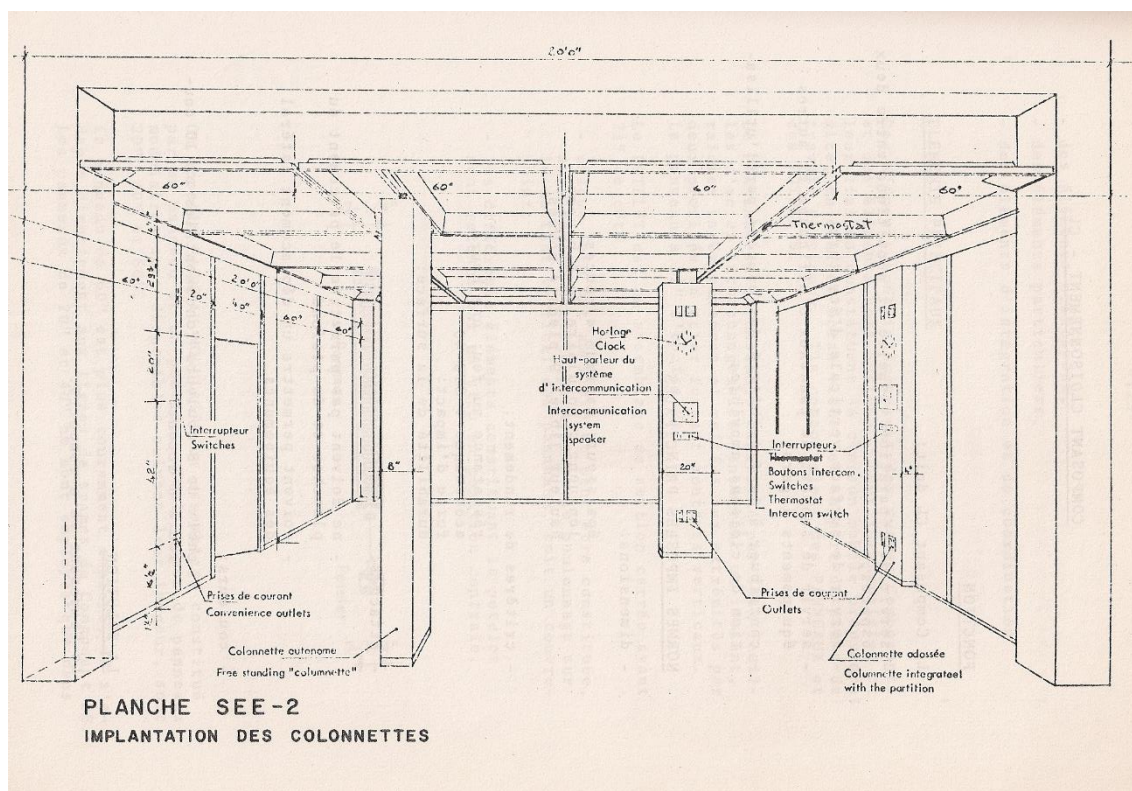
Perspectiva da implantação dos pilaretes do sistema SEE, dentro do Projeto RAS, Montreal, Canada. Fonte: CECM, 1977, p. 111.
